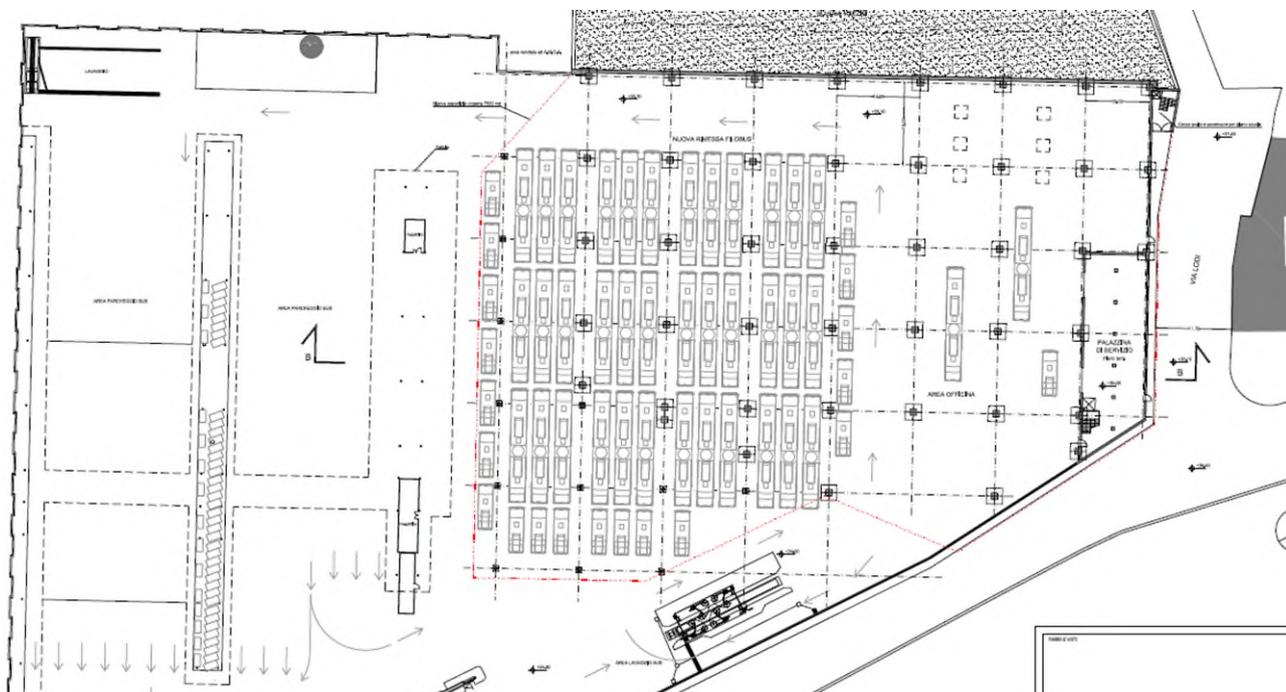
Estratto planimetria di progetto rimessa Gavette
